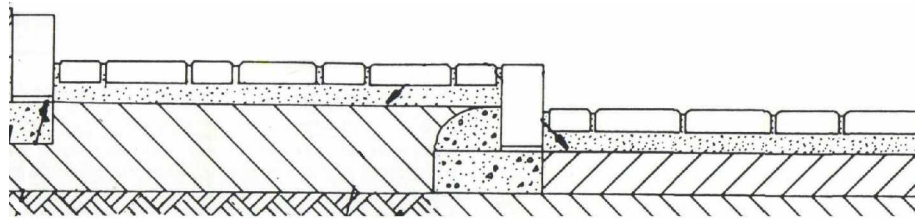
NIVELES DE PAVIMENTO EN ACERA Y CALZADA.
